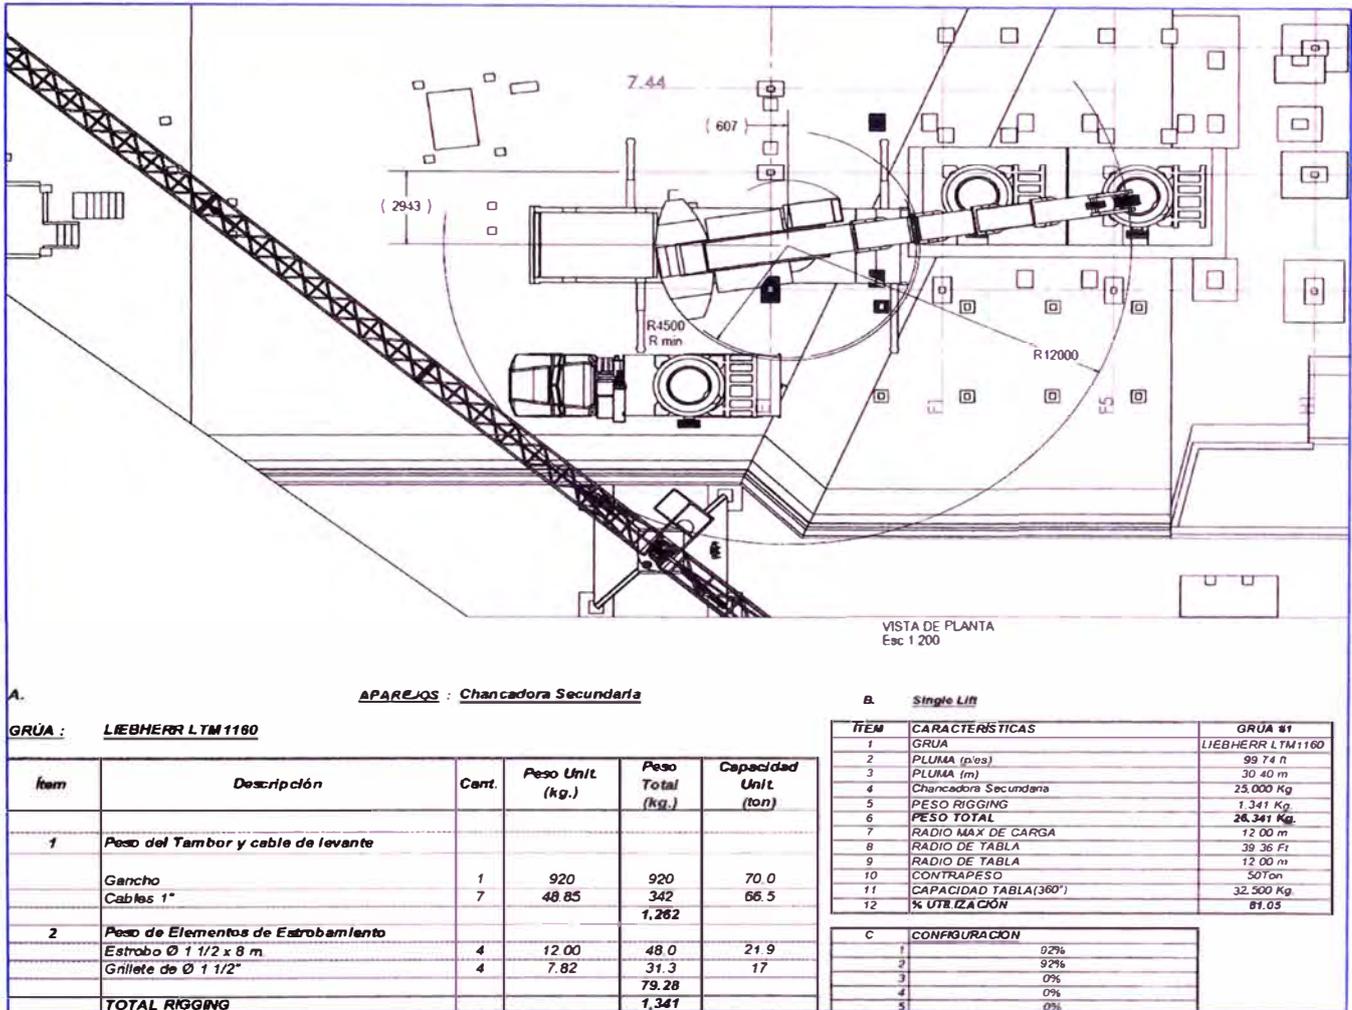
Diagrama de montaje de chancadora secundaria, vista de planta.
